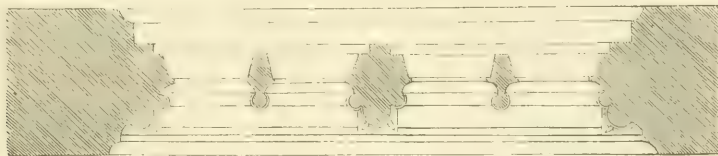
Nikolaikapelle zu Ober-Marsberg. Fenstergrundriss.
